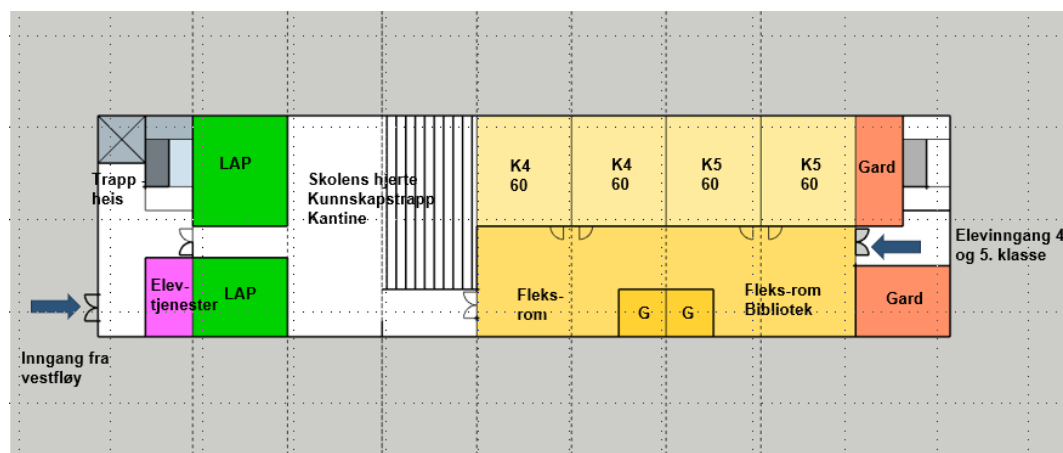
Alternativ 1, Plan 1 i ny midtfløy. Illustrasjon: Norconsult AS
